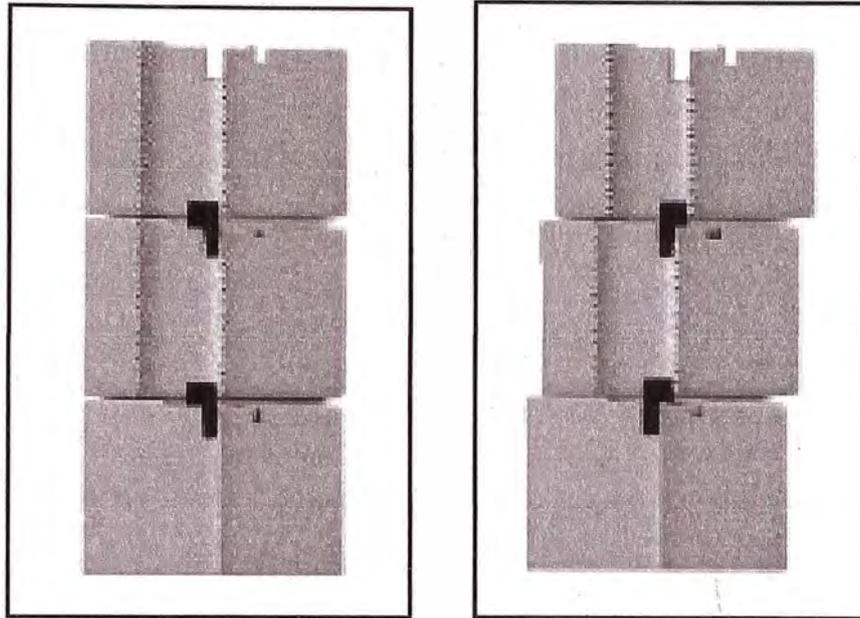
Muro de suelo reforzado – Colocación de Pines de Anclaje.
